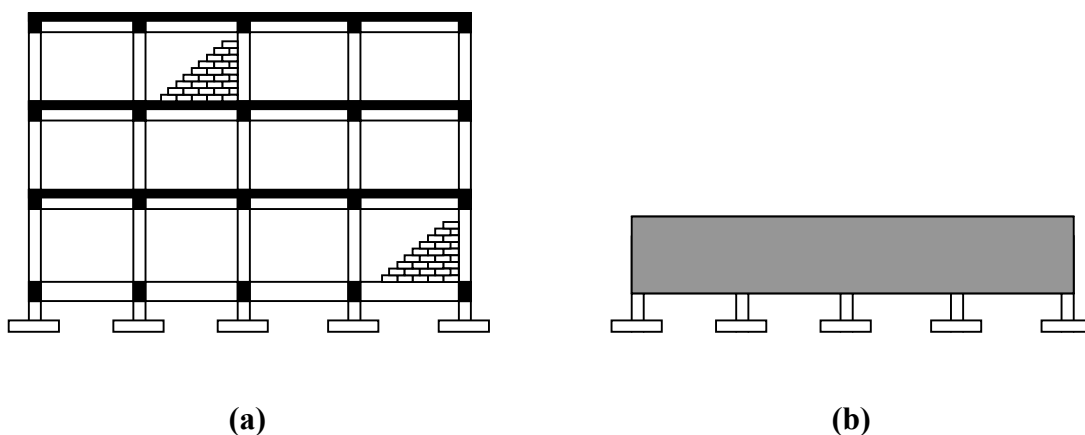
(retirada de VELLOSO e LOPES, 1997) - (a) Conjunto superestrutura + elementos de fundação. (b) Viga equivalente + elementos de fundação.
